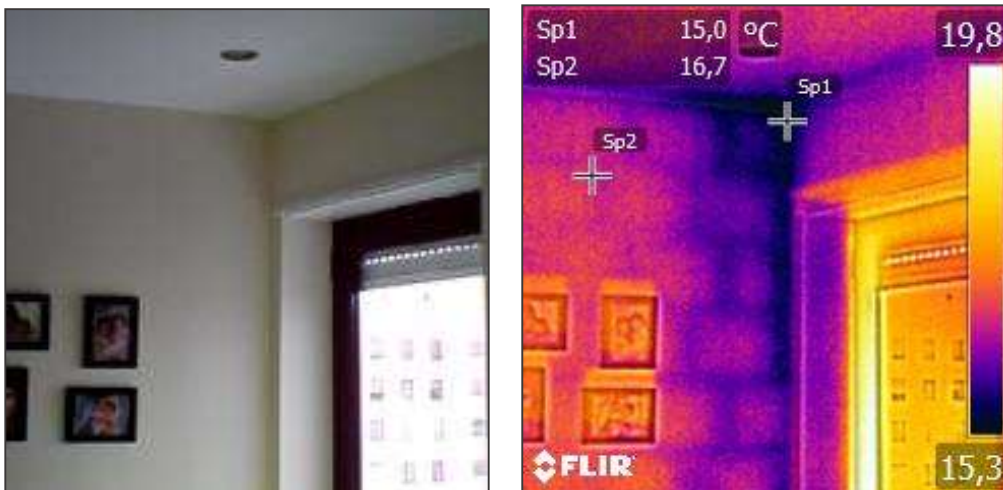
Ponte térmica na interseção de paredes exteriores e na ligação entre elementos da parede (tijolo)
